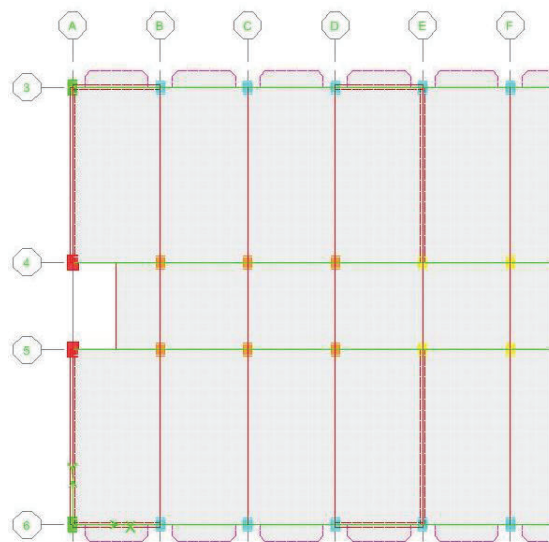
PLANTA DEL PRIMER PISO N+6.80 BLOQUE B
